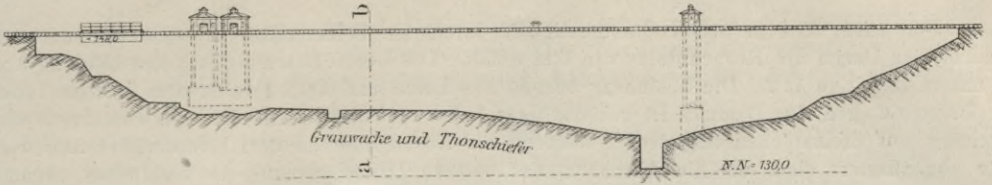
Kranbetrieb bei Herstellung des Betonkerns für den Staudamm von Jersey City.
